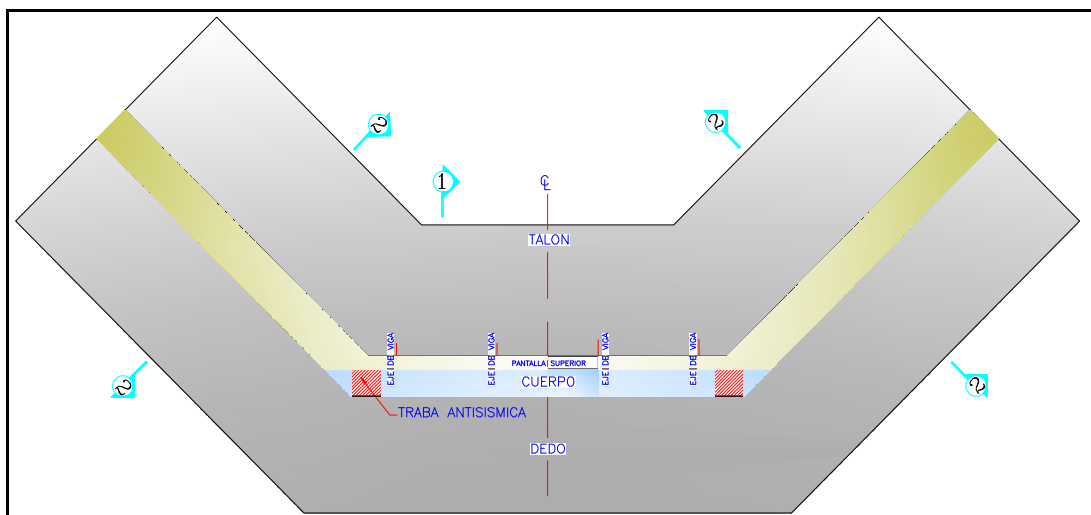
Geometría de la planta de estribos. Puente Loco.
